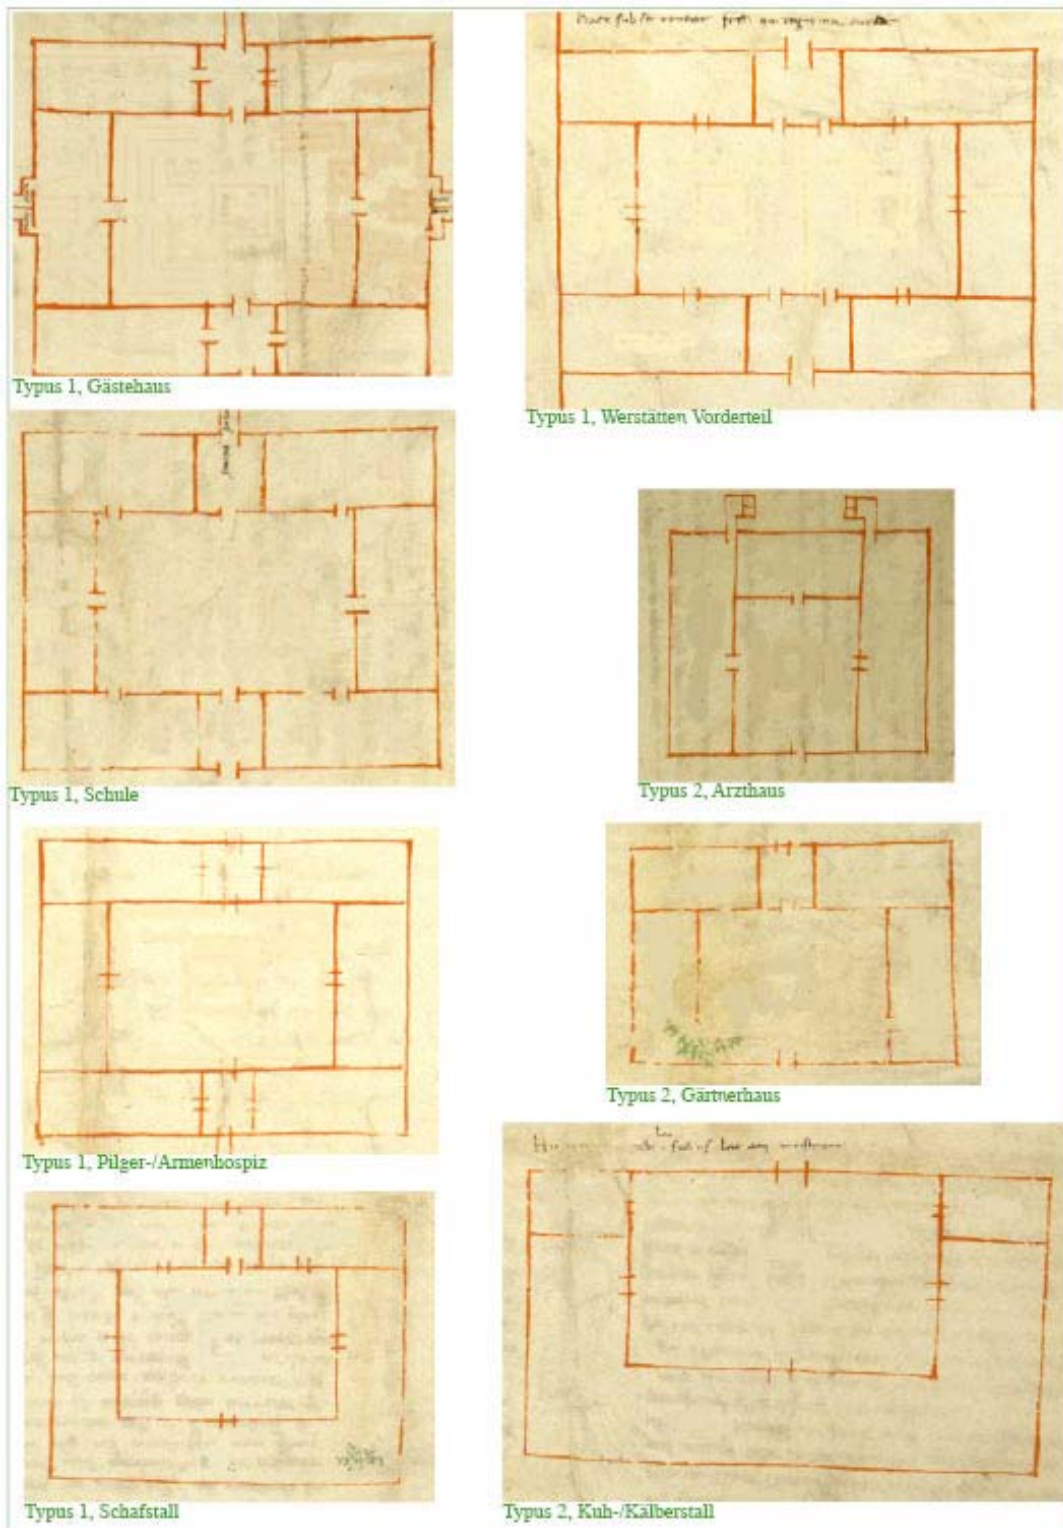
Klosterplan, Grundstruktur Gebäude, Typus 1 & 2
